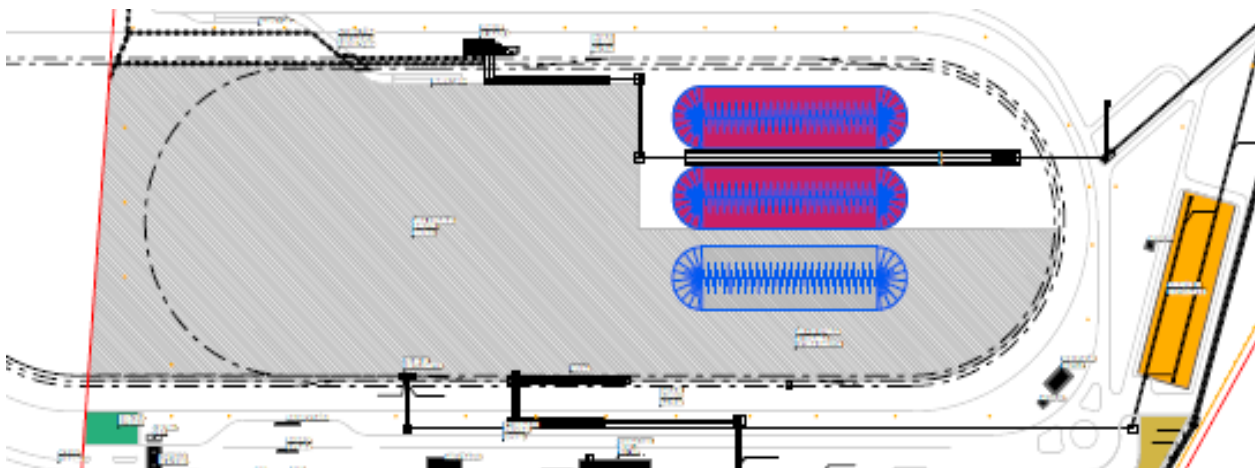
Estruturas Onshore do Terminal Portuário - área da Pera Ferroviária e pilhas de minério. Fonte: empreendedor.
